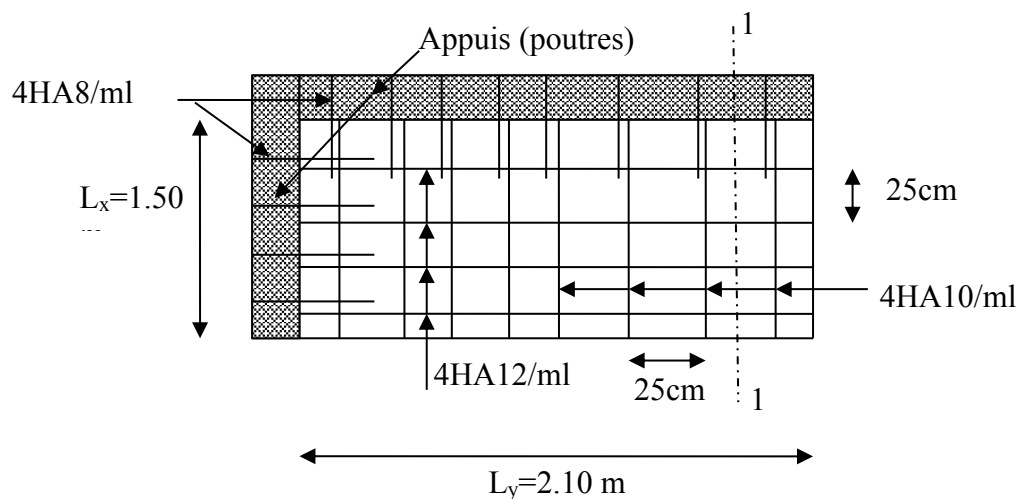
Schéma de ferrailage de la dalle sur 2 appuis.
